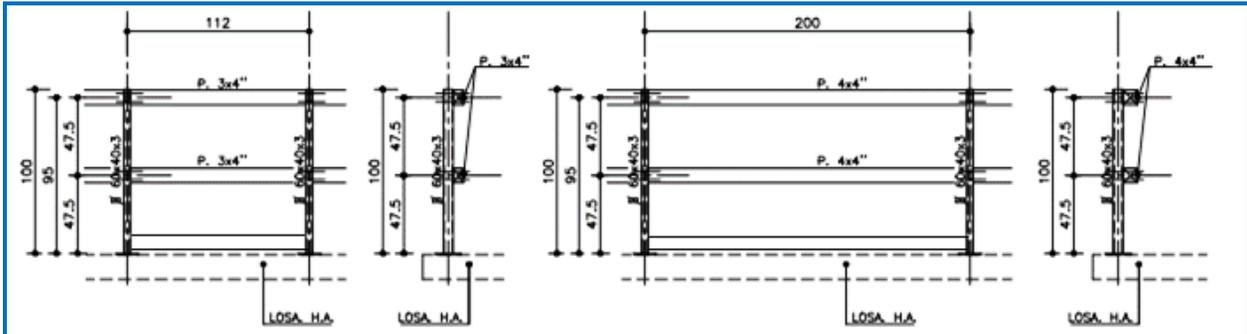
Baranda modular de perfil cuadrado metálico vertical 60x40x3 y largueros de madera 3x4" y 4x4" (medidas en cm)- Elaboración Propia
